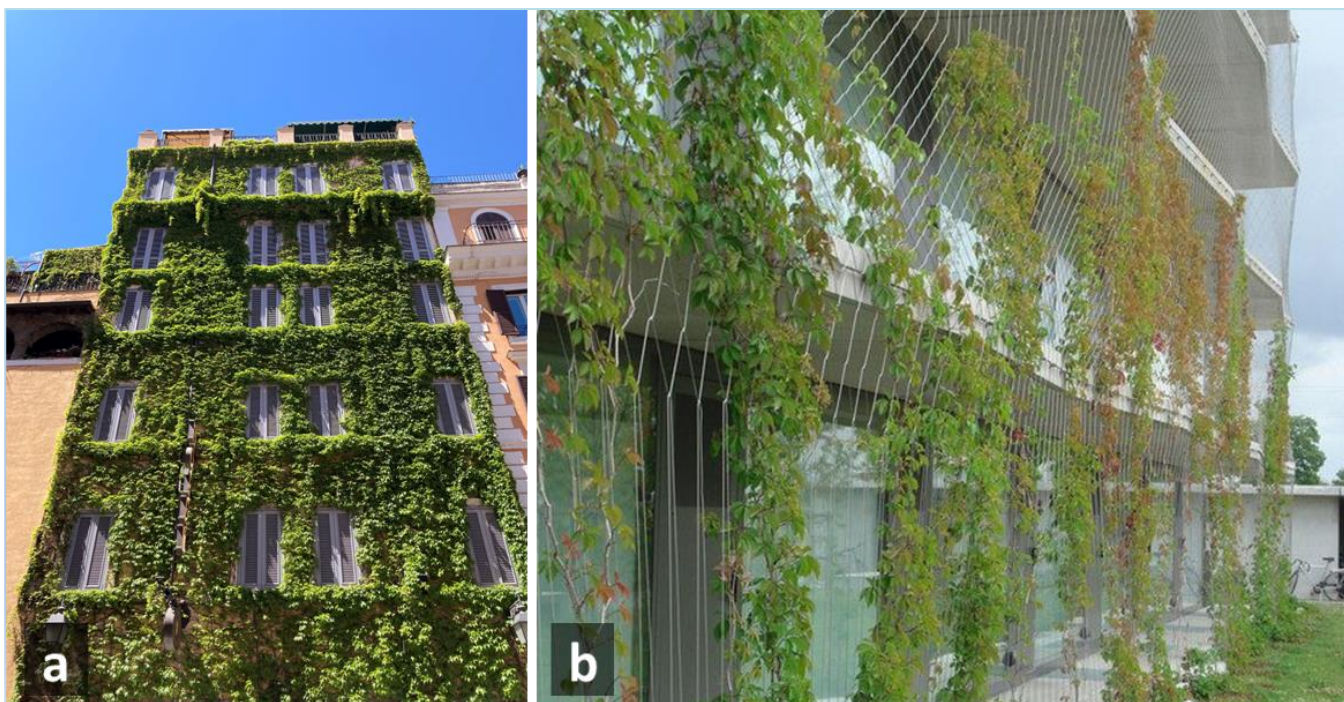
a) Facciata verde rampicante diretta, Roma. b) Facciata verde di rampicanti educata su sostegno a maglie, Germania (<https://www.carlstahl-architektur.com>).
